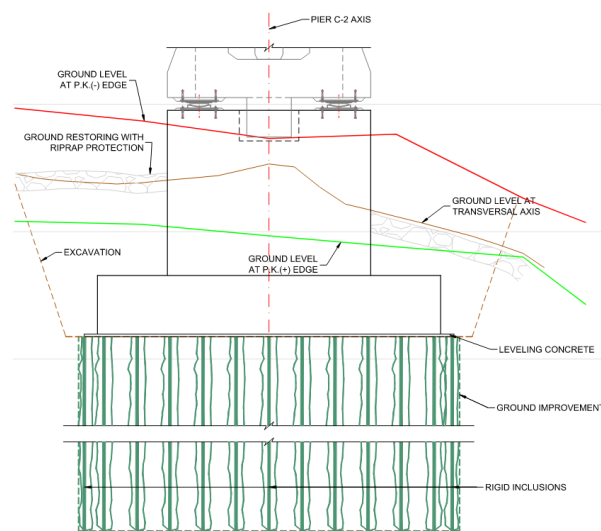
Mejora del terreno bajo las cimentaciones de las pilas. Alzado.
